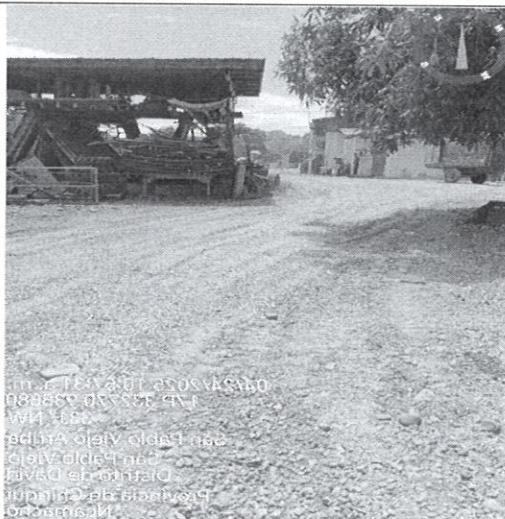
Vista de la calle interna existente dentro del proyecto.
